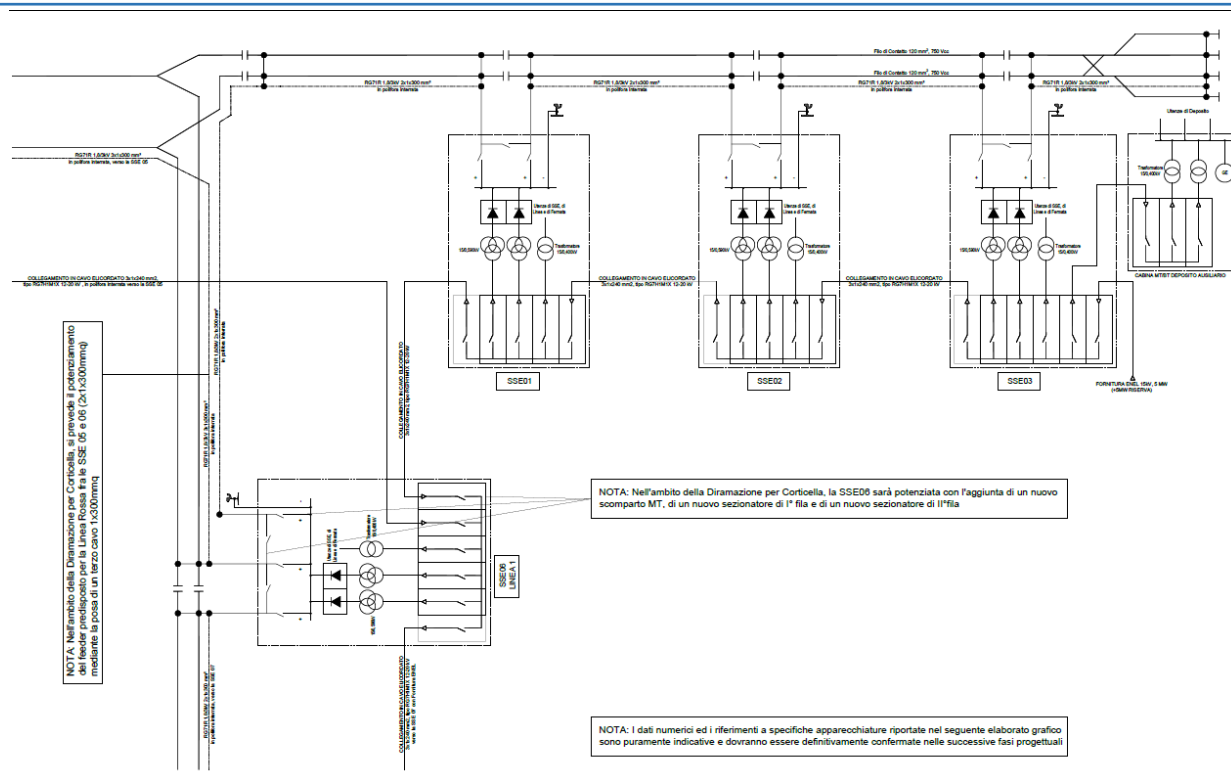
Schema delle alimentazioni e dei sezionamenti
